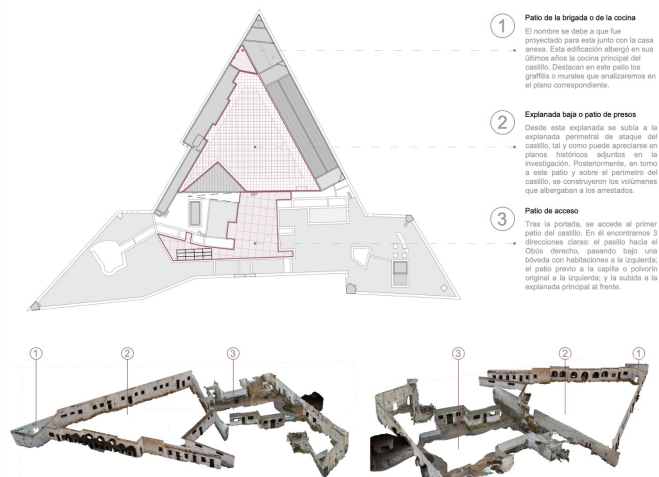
Levantamiento interior. Conjunto de patios. Elaboración propia.
